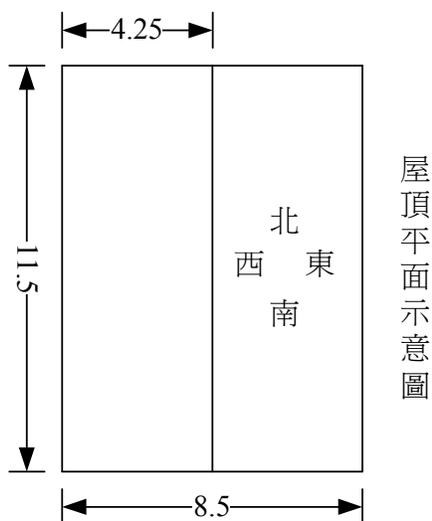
低層建築物屋頂平面示意圖 單位 (m)
